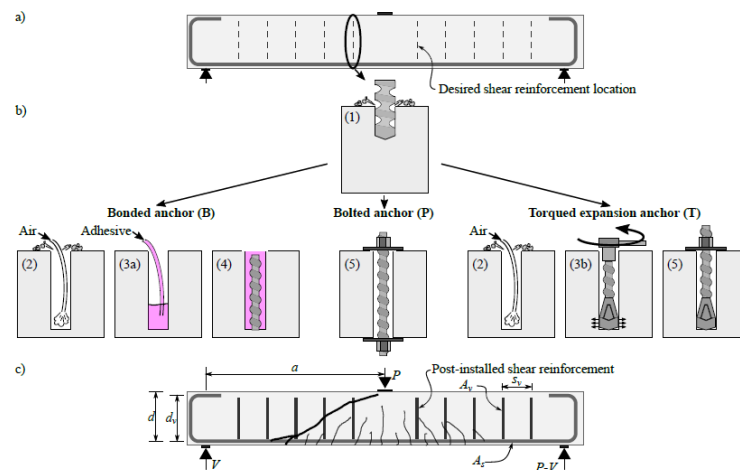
a) Renforcement à l'effort tranchant d'une tranche de dalle épaisse, b) L'installation de 3 types de renforcement ETS c) chargement d'un spécimen renforcé (tirée de Fiset (2019))
